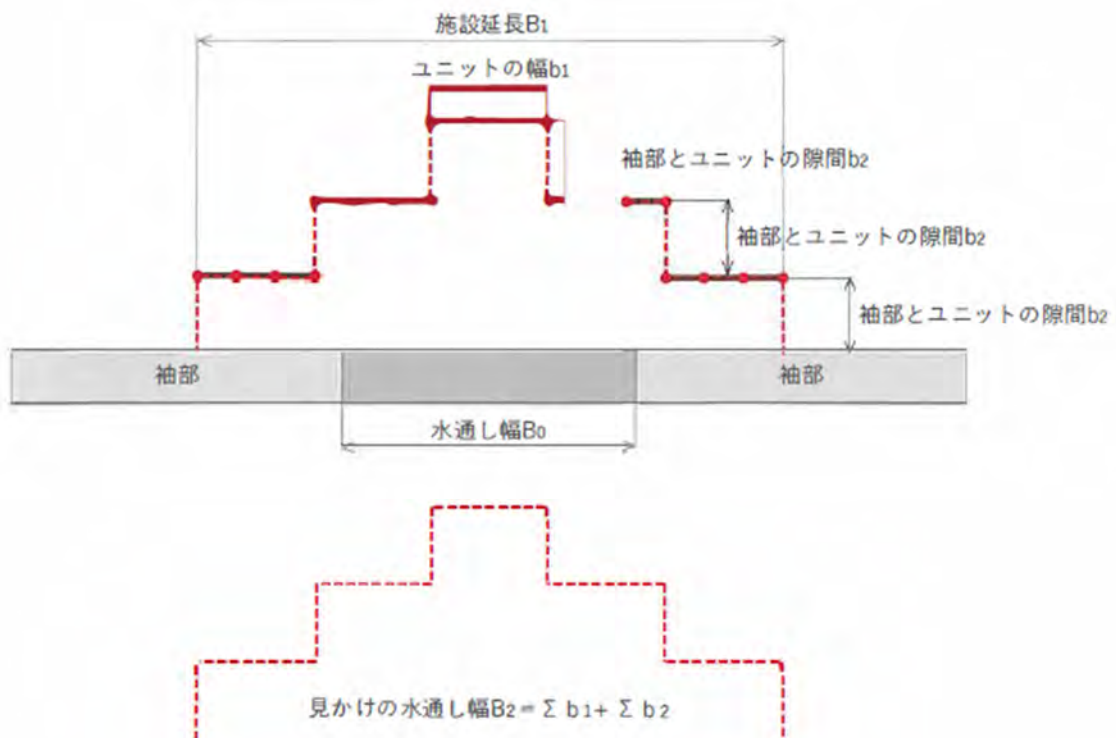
張出しタイプ流木捕捉工の設置延長
